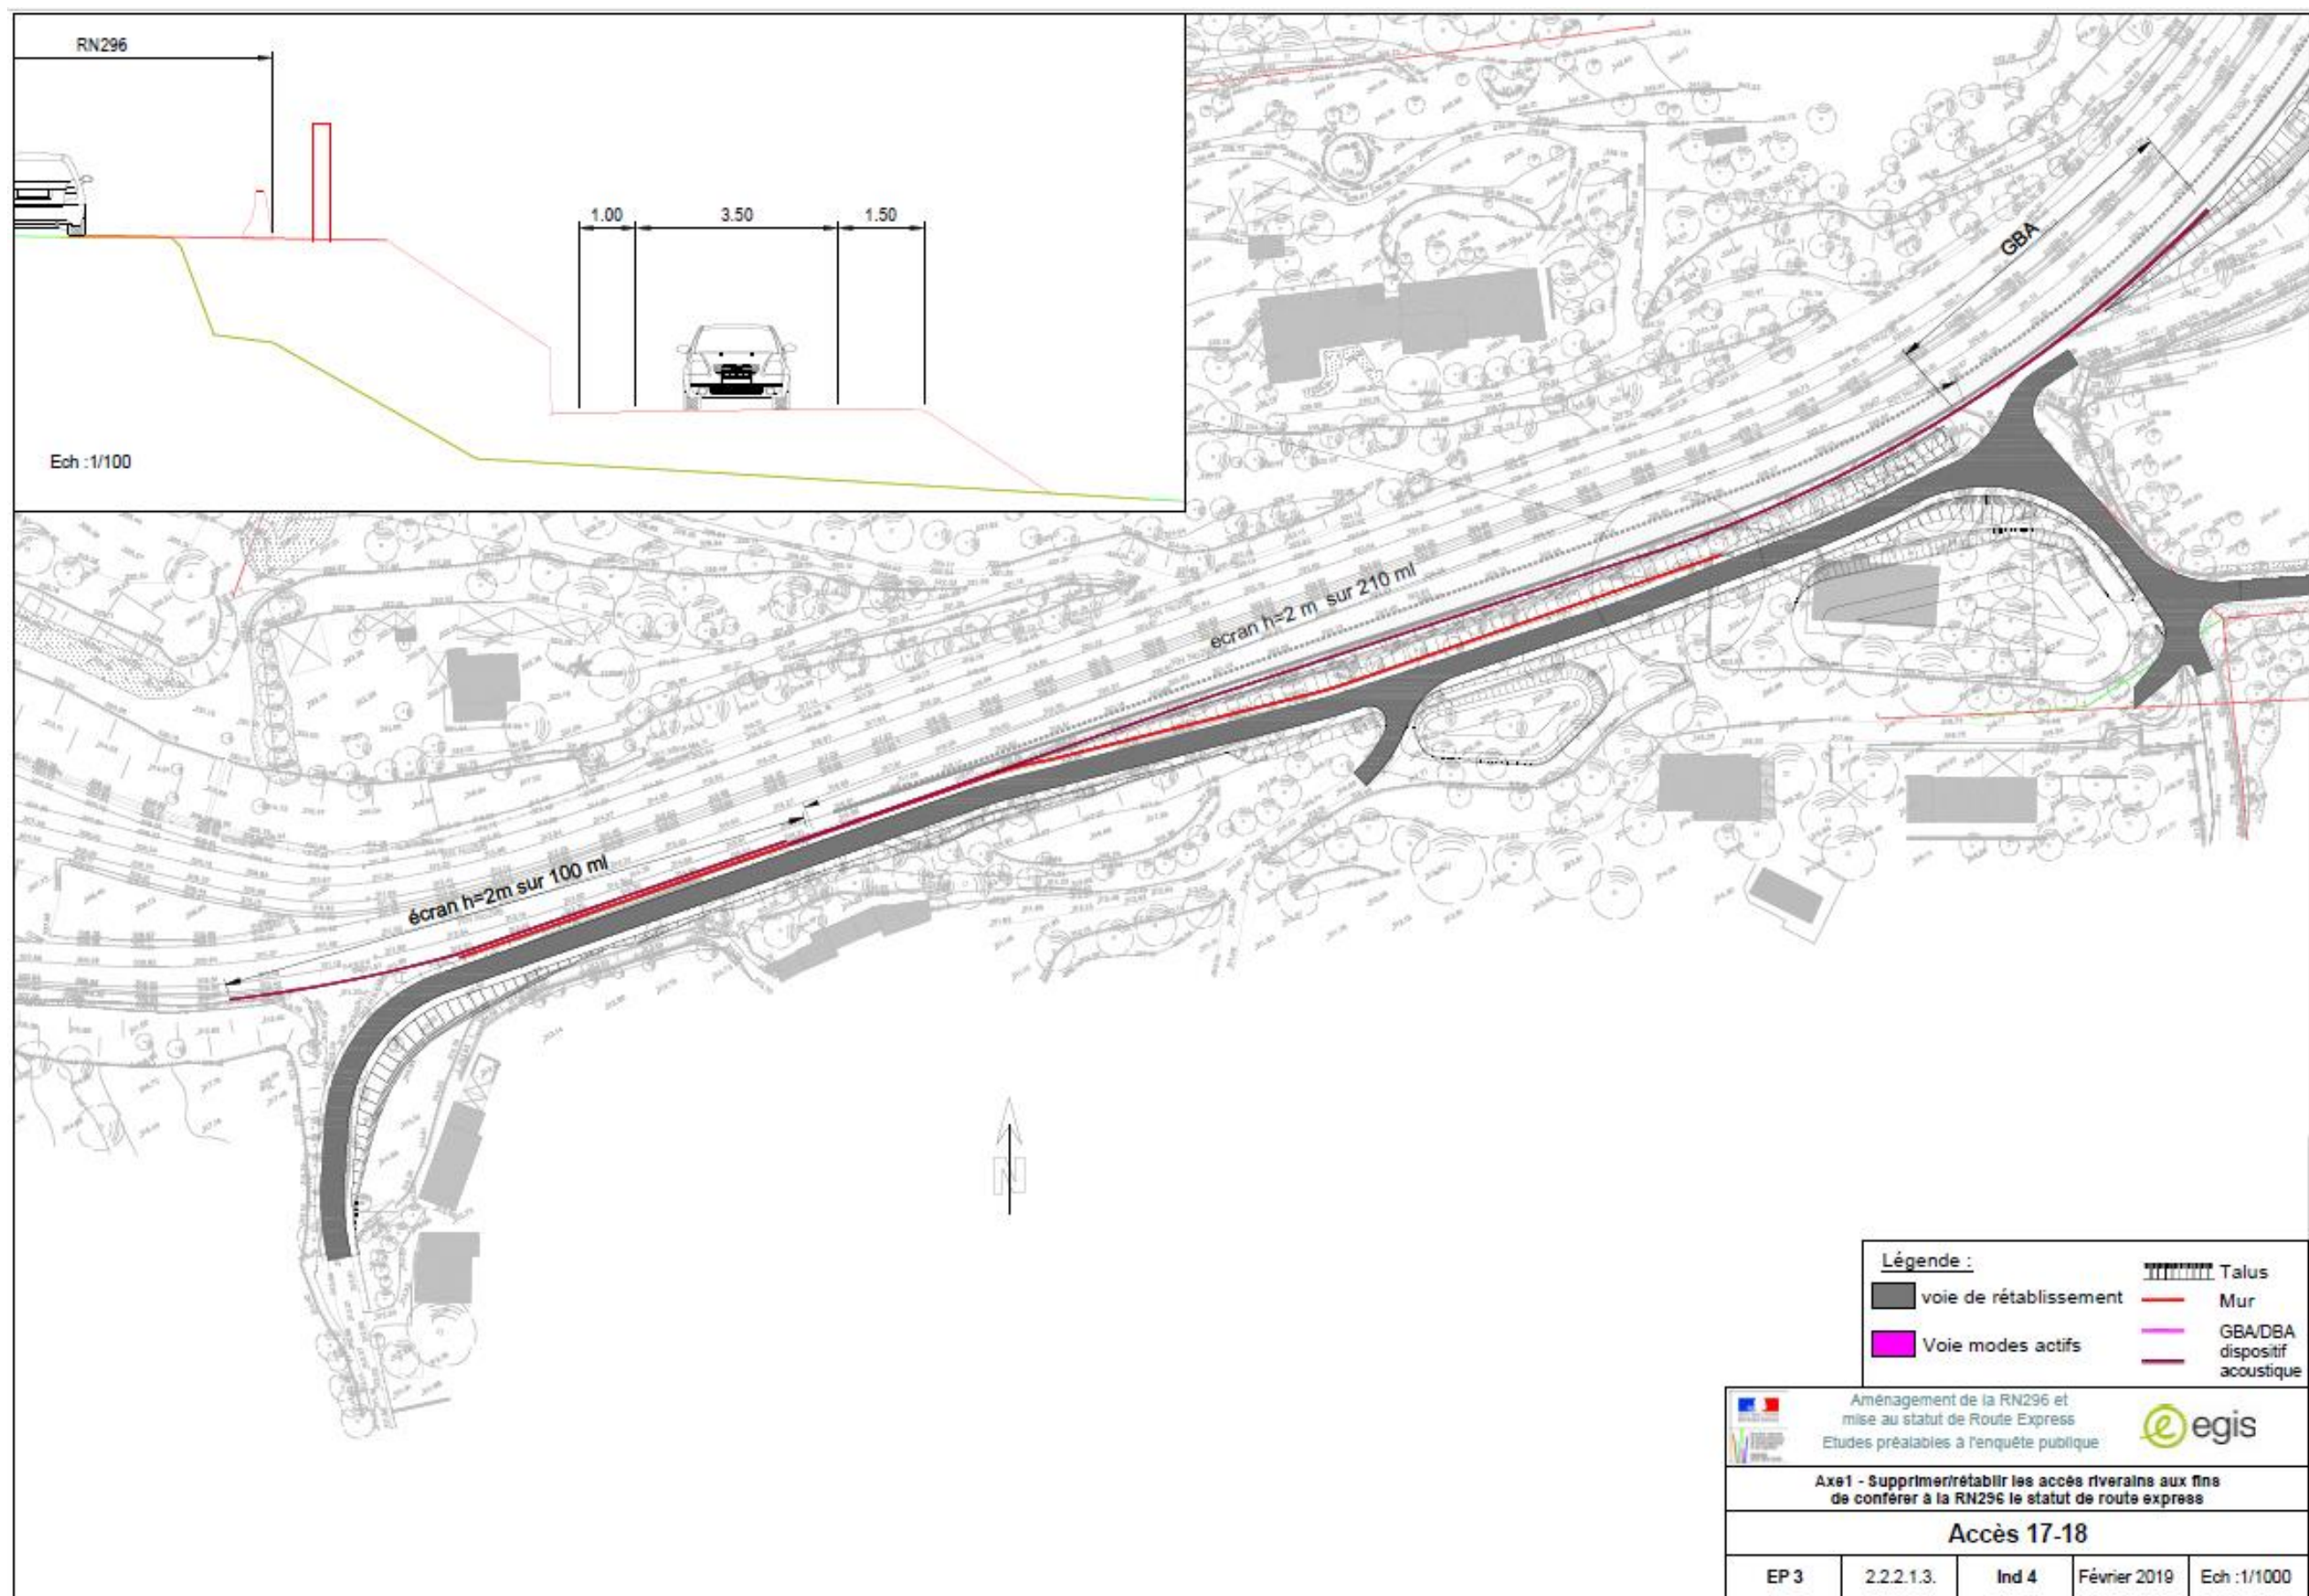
Profil en travers et vue en plan du réaménagement des accès 17 et 18
